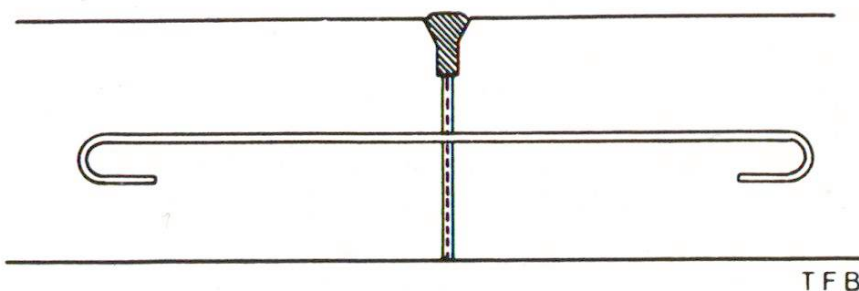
Coupe d'un joint longitudinal de route en béton. Dalles exécutées à des époques différentes. Avant de bétonner la seconde, on a enduit la tranche de la première avec un produit bitumineux. Obturation au mastic à la partie supérieure. Goujonnage en fer rond
